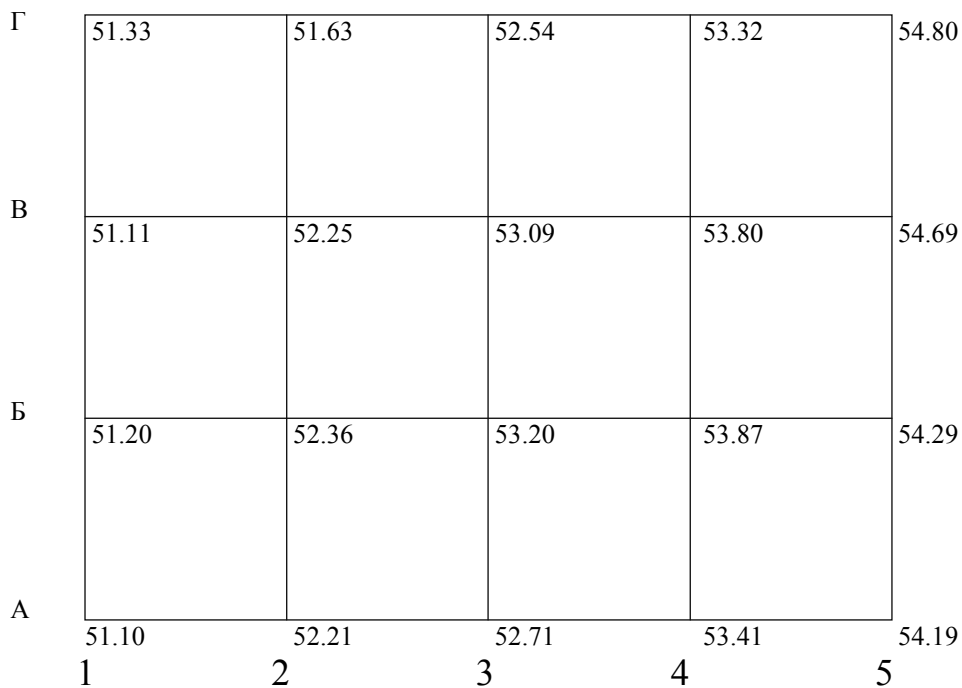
Схема площадки с абсолютными отметками вершин квадратов
